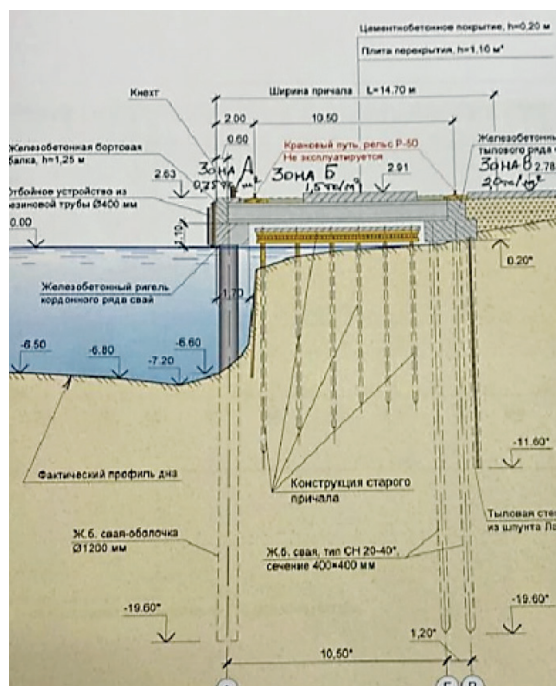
Конструкция железобетонного причала с подкрановыми и железнодорожными путями
